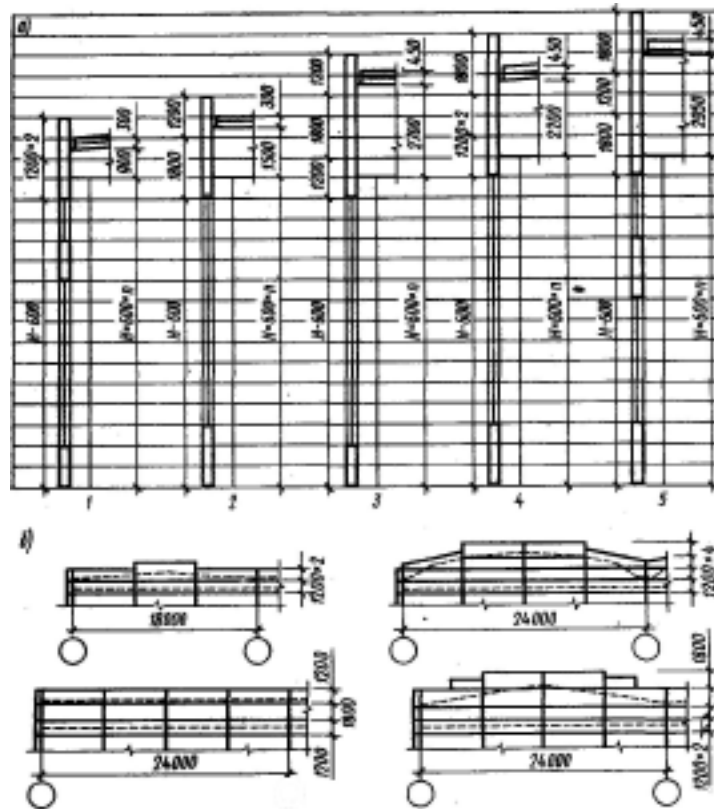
Варианты разрезки стен одноэтажных зданий:
